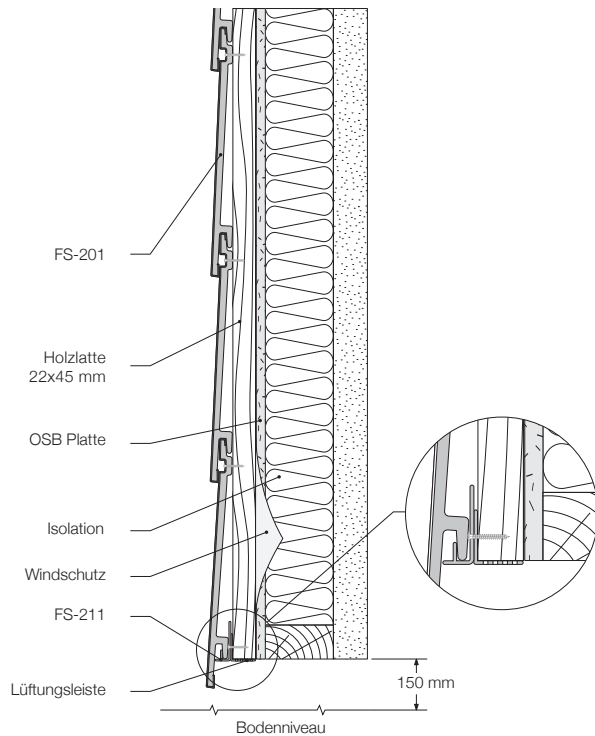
KERRAFRONT Doppeltes Paneel an der Wand, Gerüstkonstruktion - Längsschnitt
